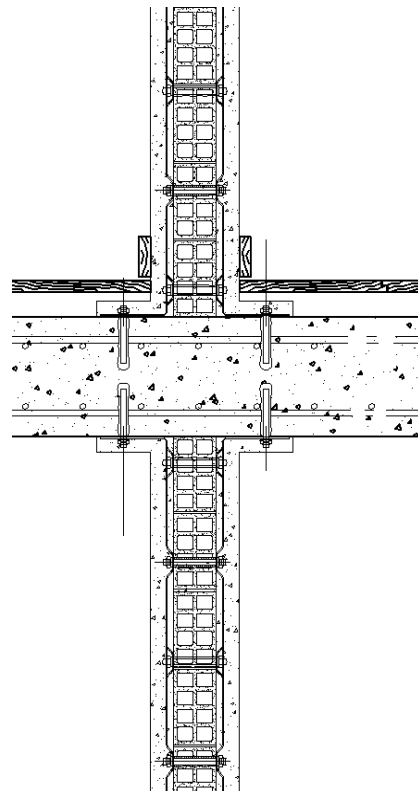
Pormenor da ligação do reforço das alvenarias existentes à laje do chão
